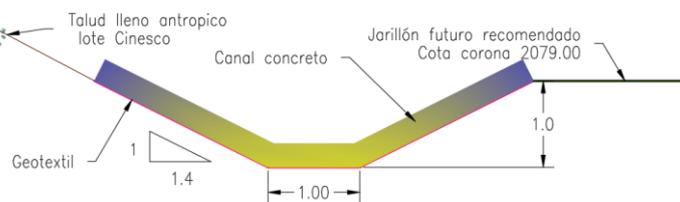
Tipo de la Obra:			Canal Trapezoidal 1
